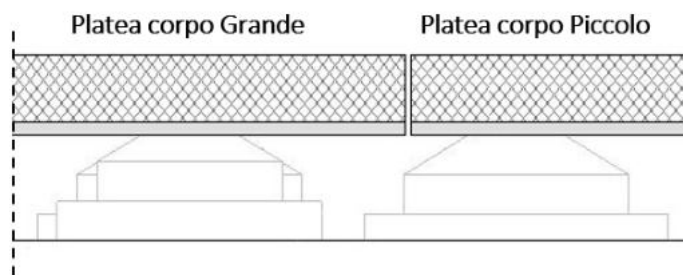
Nuove platee giuntate gettate sul sistema fondale esistente
